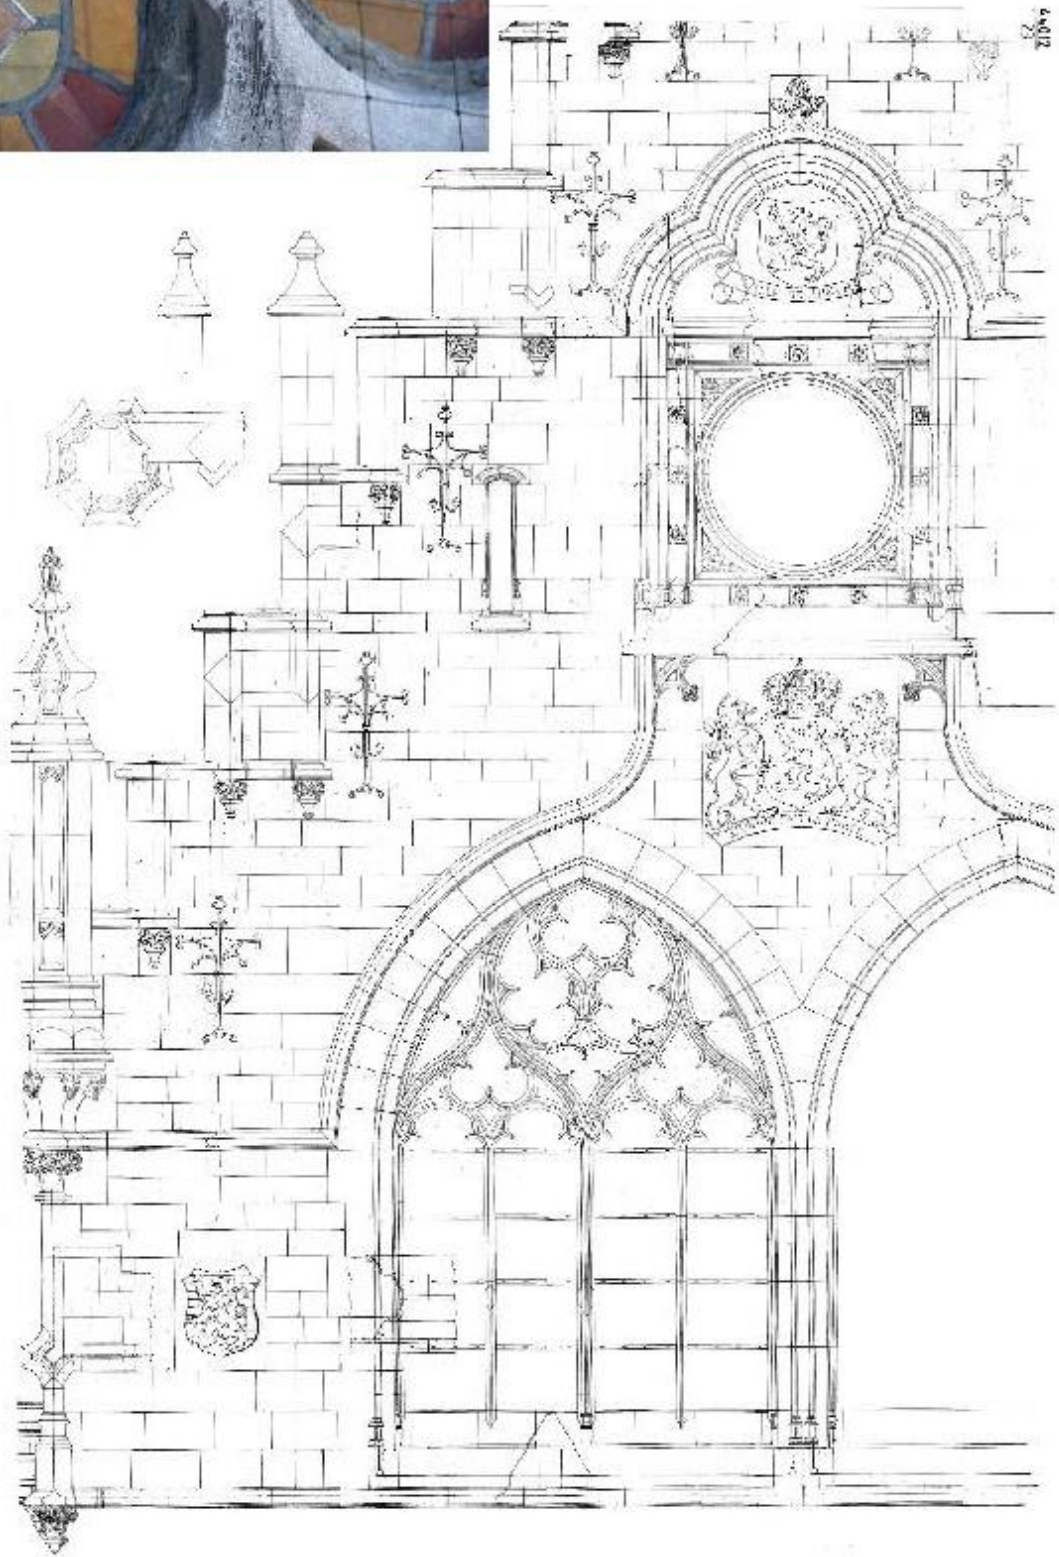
Plans originaux du pignon de la façade avant avec l'horloge
